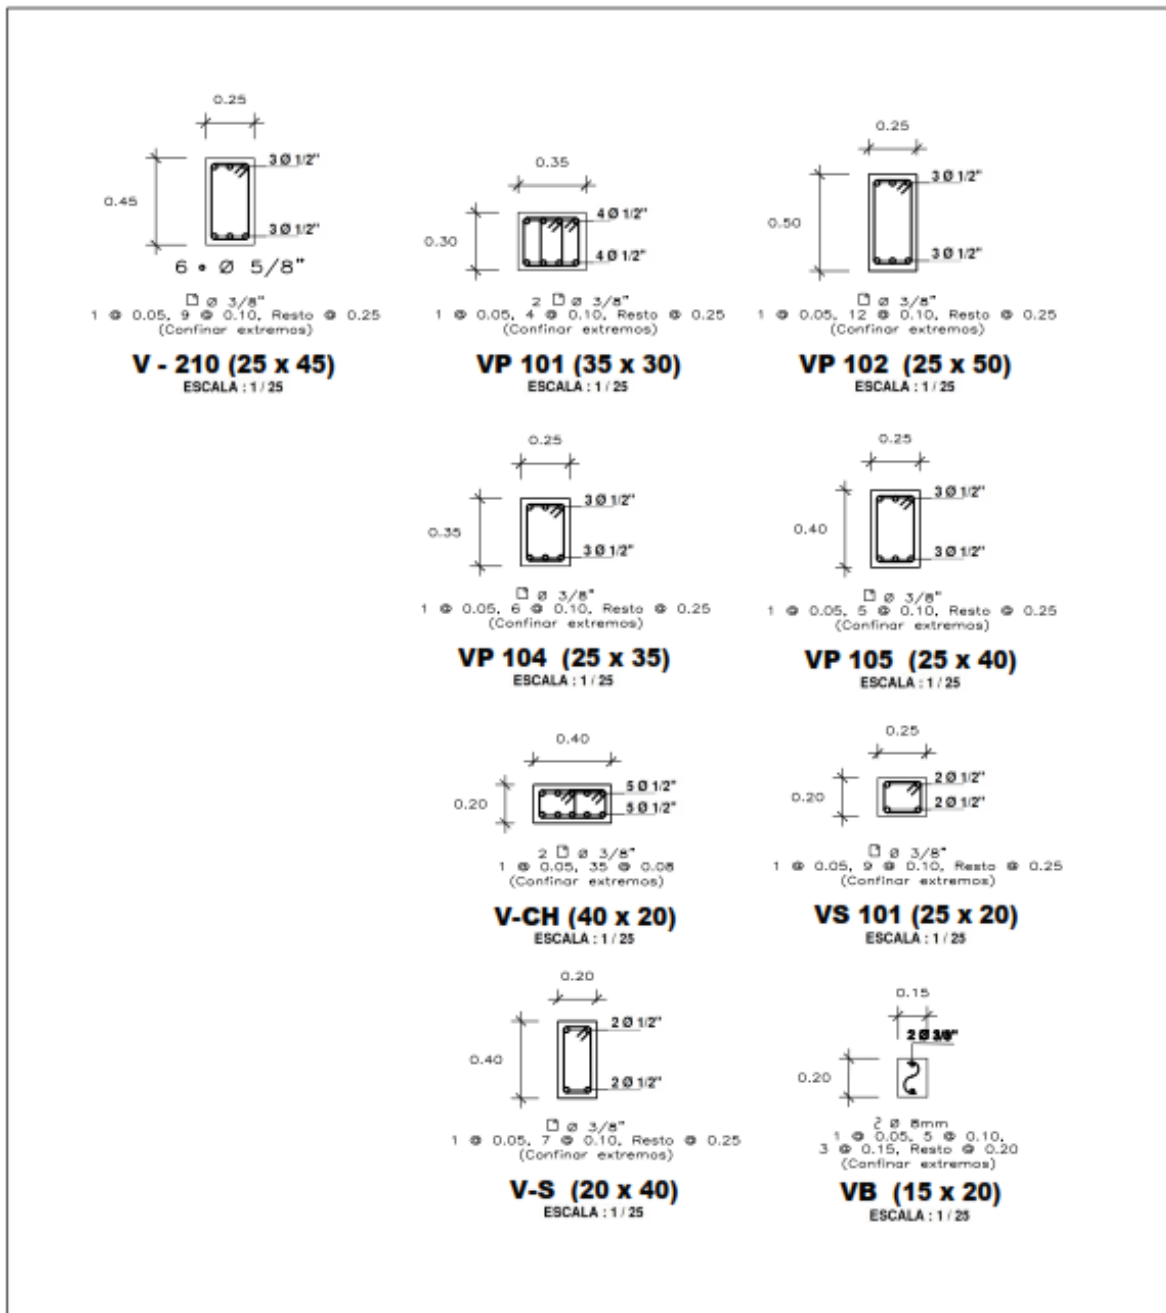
Secciones de vigas y distribución de acero para 5° nivel.
